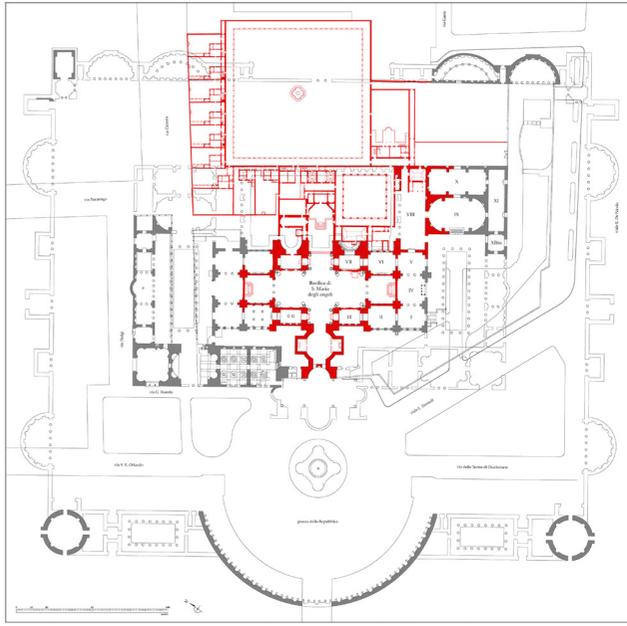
Planimetria generale con le strutture della Certosa sovrapposte all'impianto antico (rilievo MCM s.r.l.).
